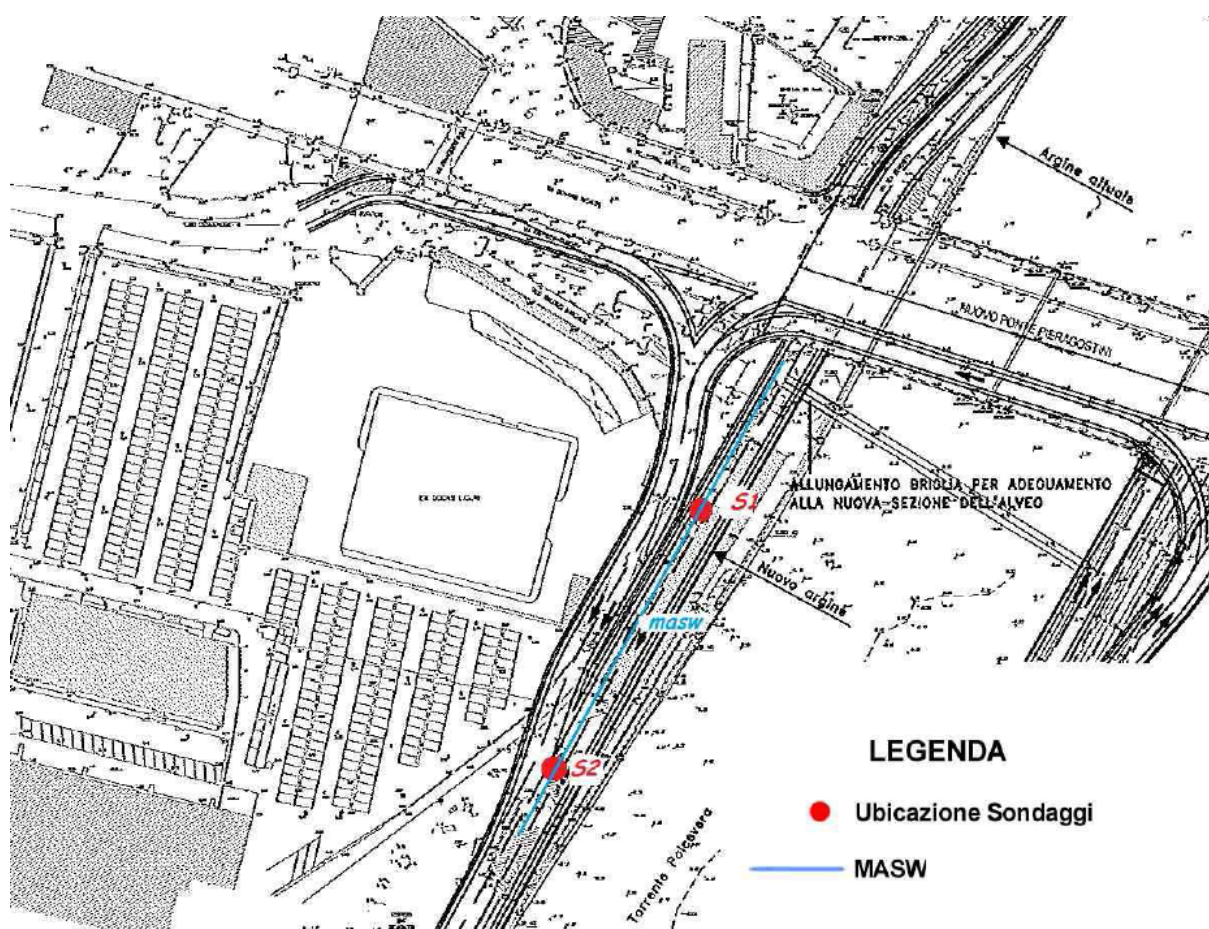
Ubicazione planimetrica del sondaggio MASW.
